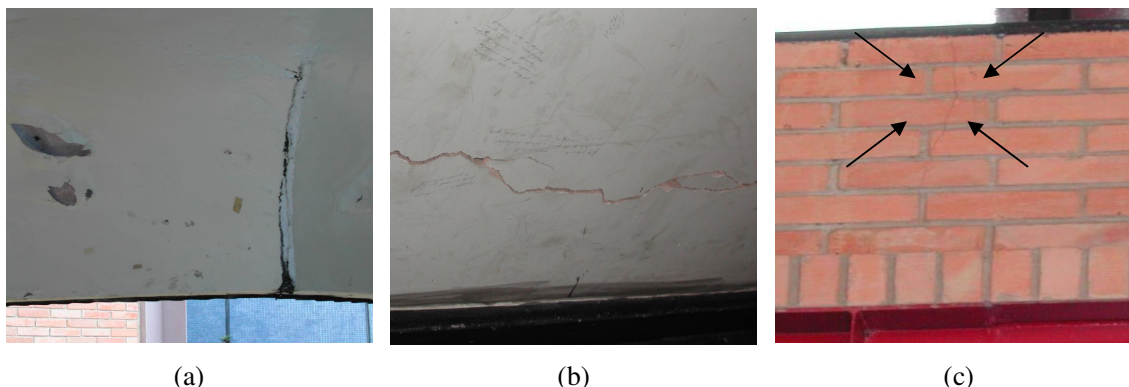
Fissura em cobertura (a), fissura horizontal (b) e vertical (c) em fechamento de alvenaria
